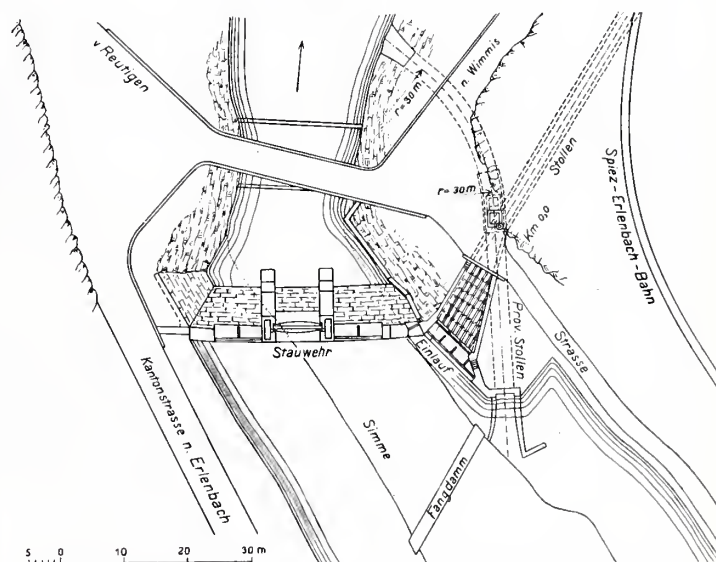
Lageplan des Simmewehrs mit dem Stolleneinlauf.
